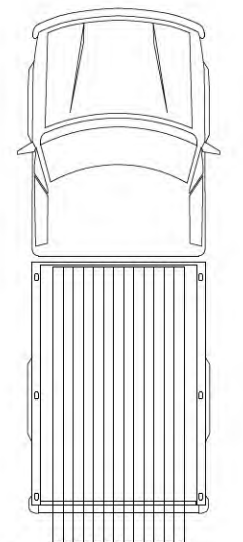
Piezas de cercha ordenadas para transporte en cabina de Pick-up.
